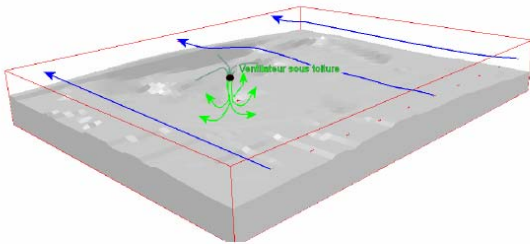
Schéma de principe de la ventilation de la halle pour le concept 2 (sans tenir compte des captages au point haut et au point bas, ni du captage dans la zone des wagonnets): Ventilateur au plafond. La figure ne montre qu'un seul des 52 ventilateurs prévus au plafond. Vert clair: zone de soufflage. Vert foncé: zone de captage. Bleu: direction de l'écoulement d'air frais et évacué de la halle.
